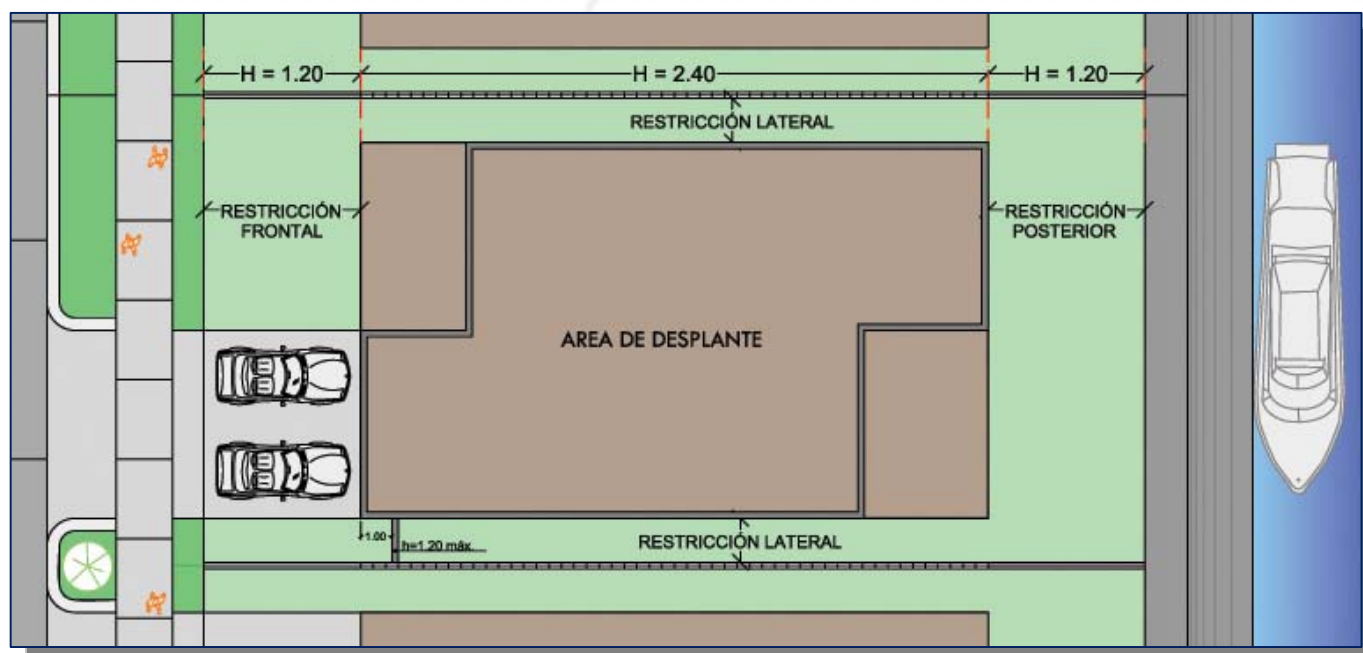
B PLANTA DE MURO DE COLINDANCIA EN LAS UNIDADES CONDOMINIALES
